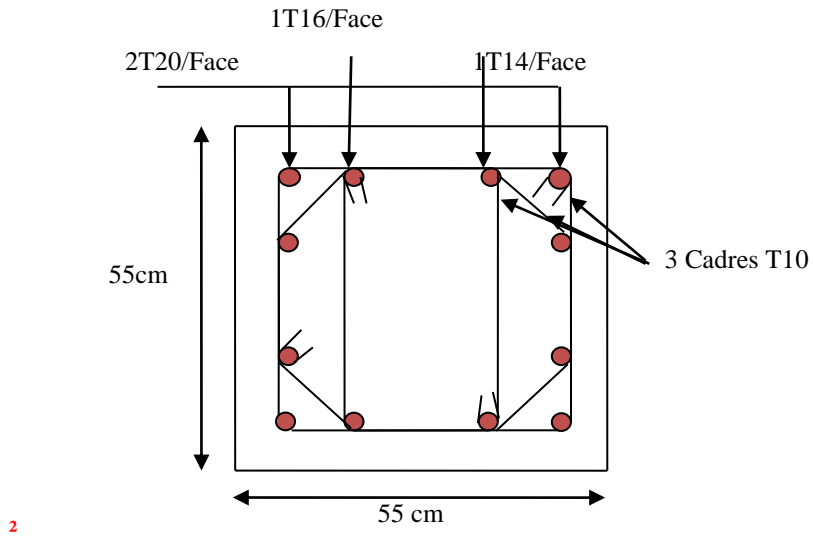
Schéma de ferrailage des poteaux de 4, 5,6 étages.
